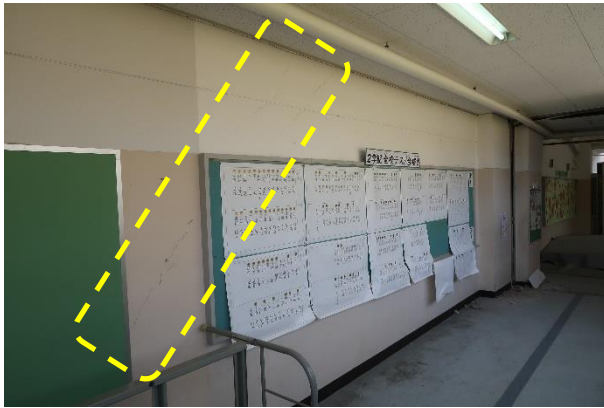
建築物 C-3 耐力壁のひび割れ
